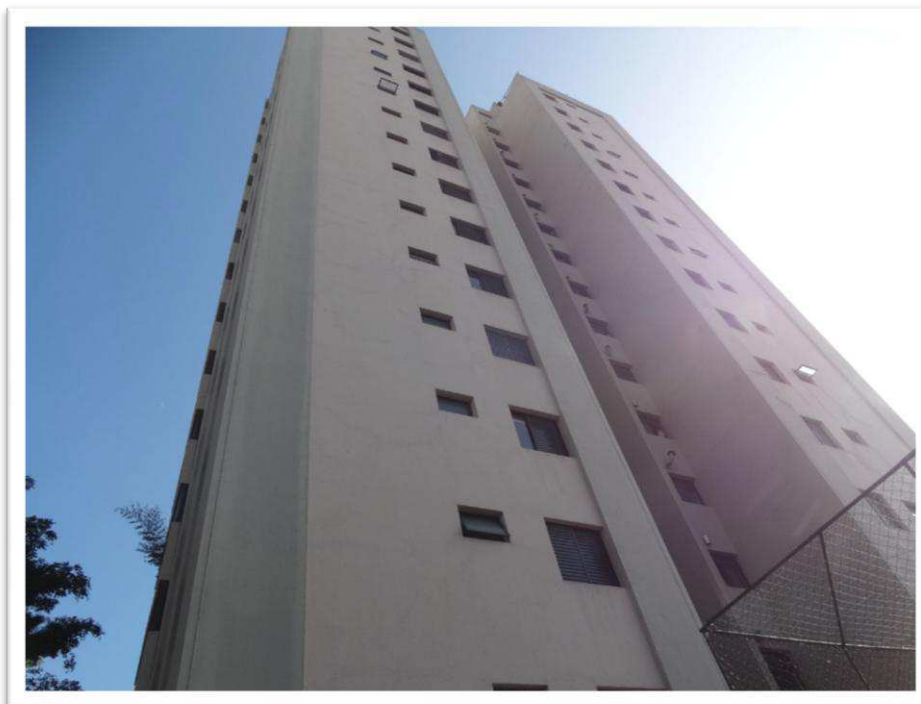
Vista da fachada lateral direita do Bloco “B”.
